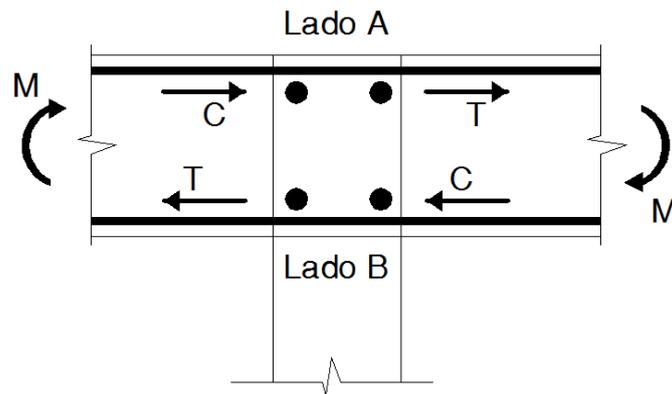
Vista en planta de la intersección de dos vigas, y las fuerzas que se generan ante una deformación.
